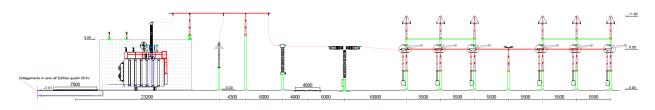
Sezione futuro stallo di arrivo in Stazione Elettrica RTN
